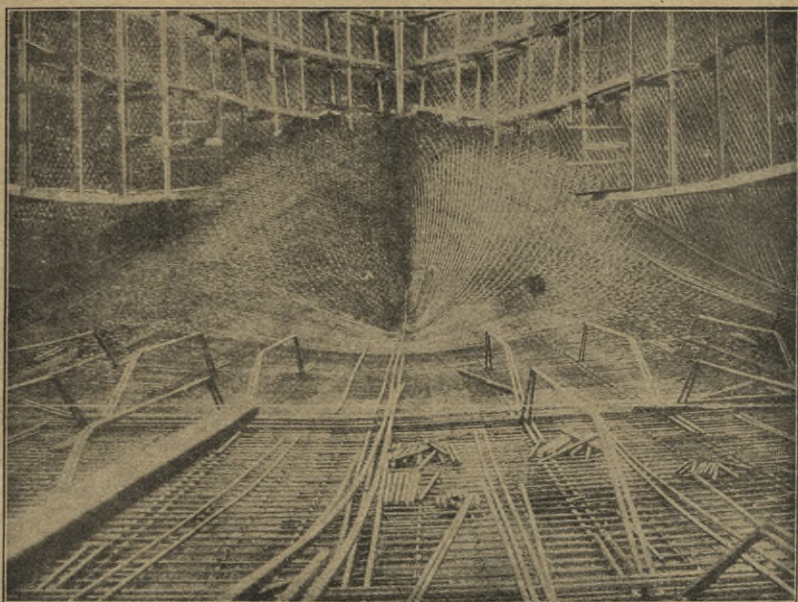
Eisenbetonschiff von 7900 Tonnen, Bauweise Alan Mac Donald und Kahn.
